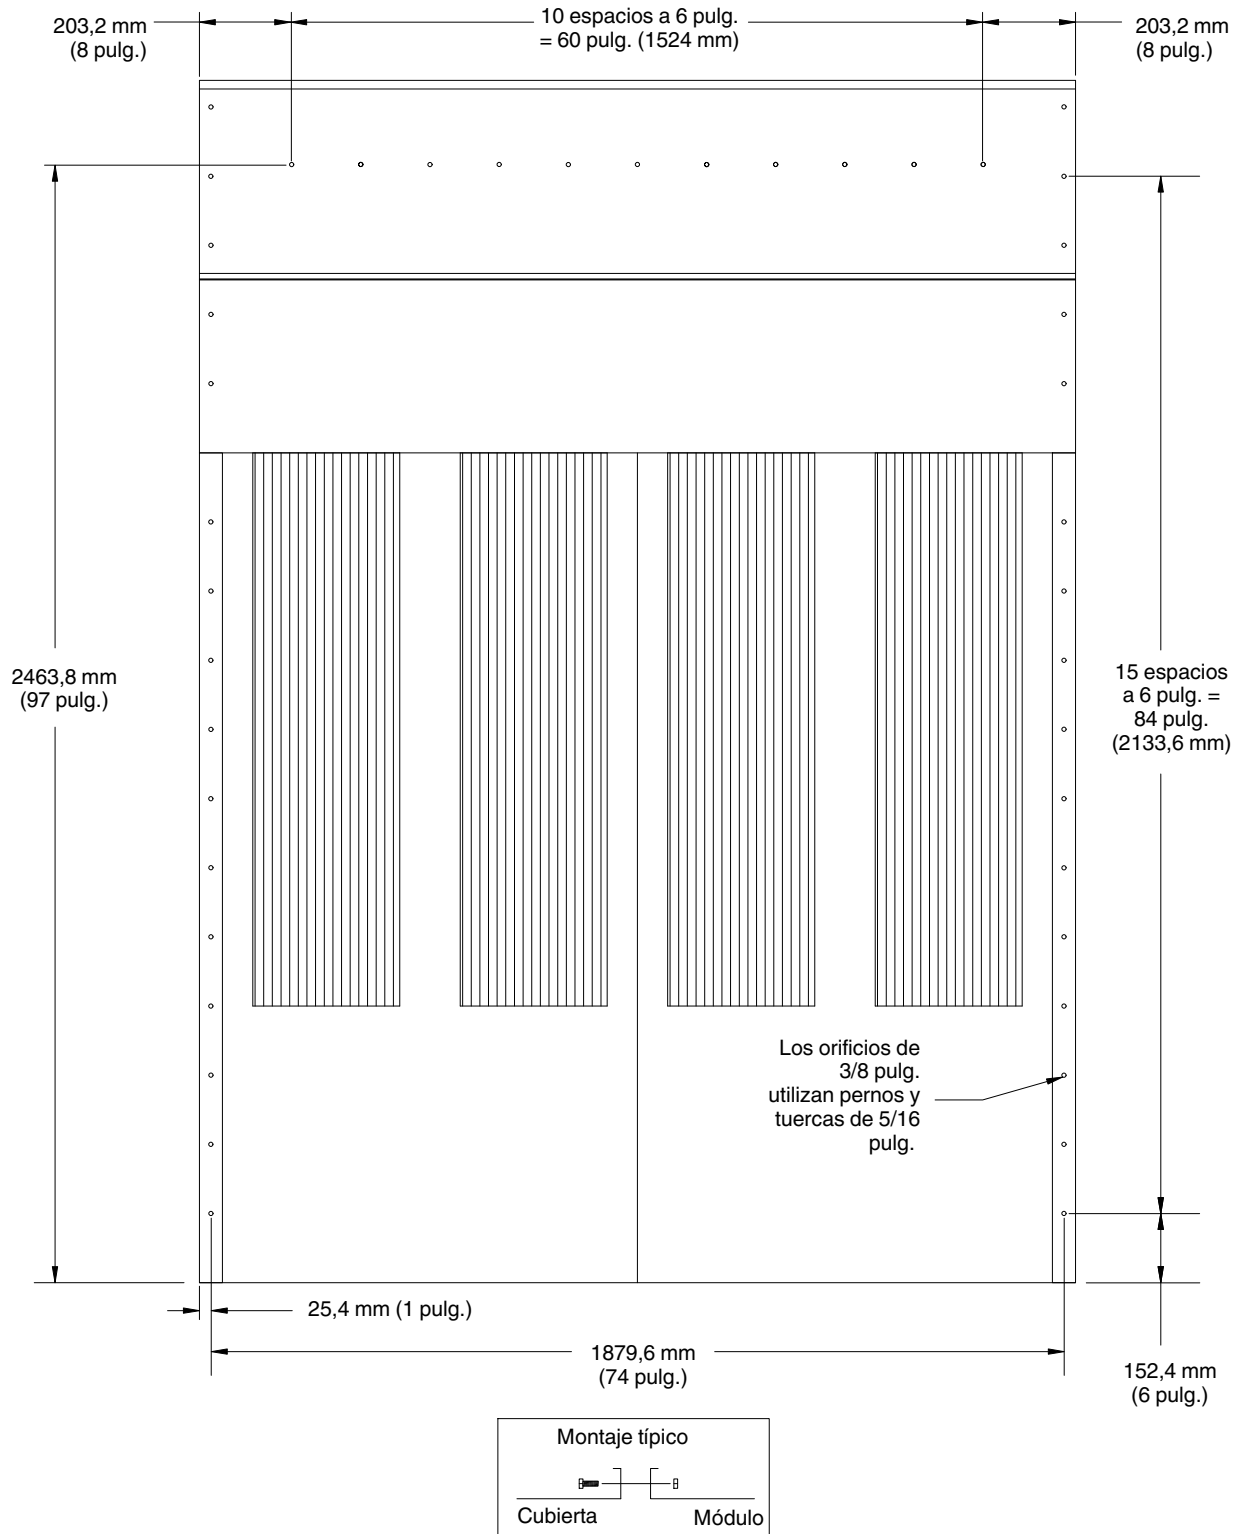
Dimensiones de montaje de módulo de 6.000 pcm a cubierta
